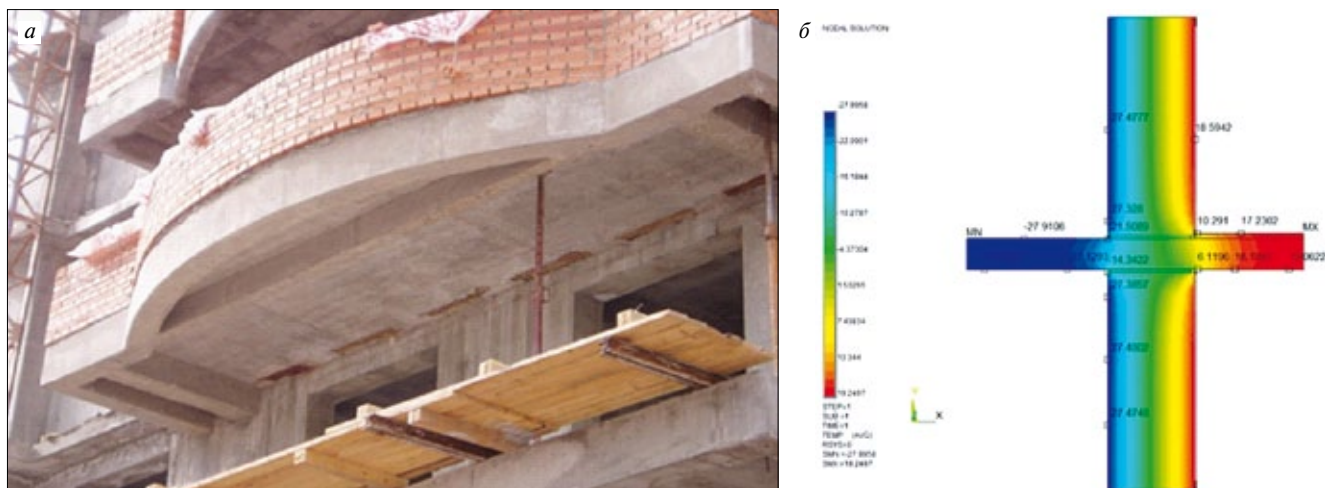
Сопряжение наружной стены с балконной плитой: а – общий вид; б – температурное поле узла в зоне монолитного армированного участка
